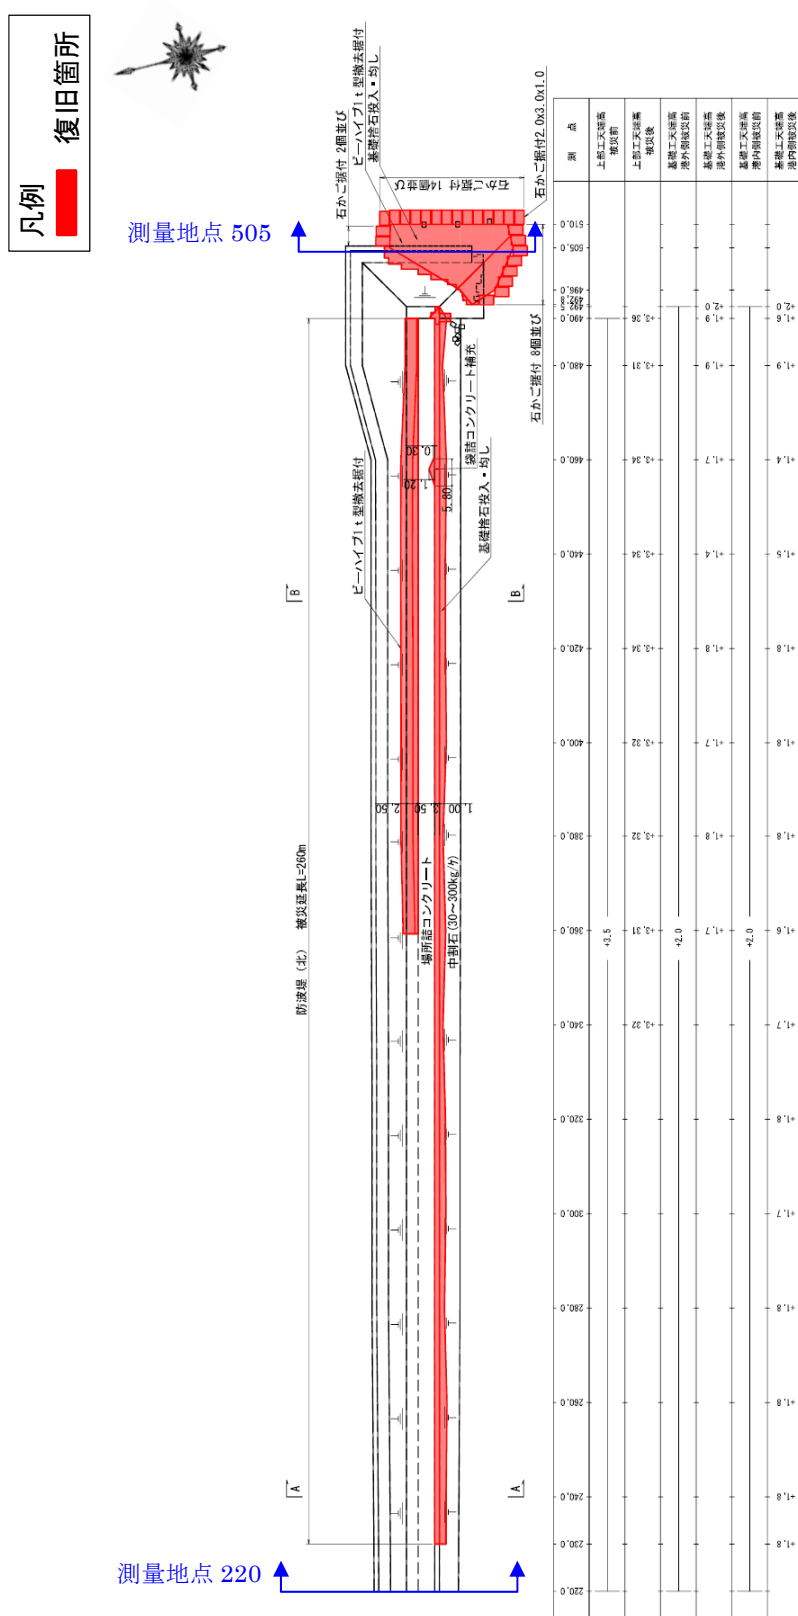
No.8 北防波堤の平面図（復旧後）
